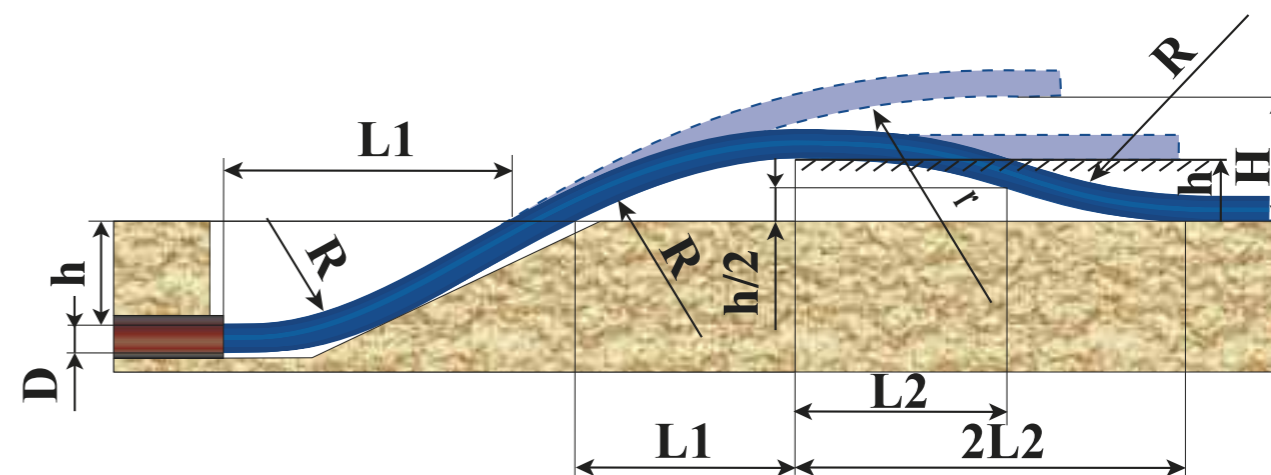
Укладка трубы ПРОТЕКТ в существующий трубопровод с поднятием трубы над поверхностью земли для сокращения длины котлована
